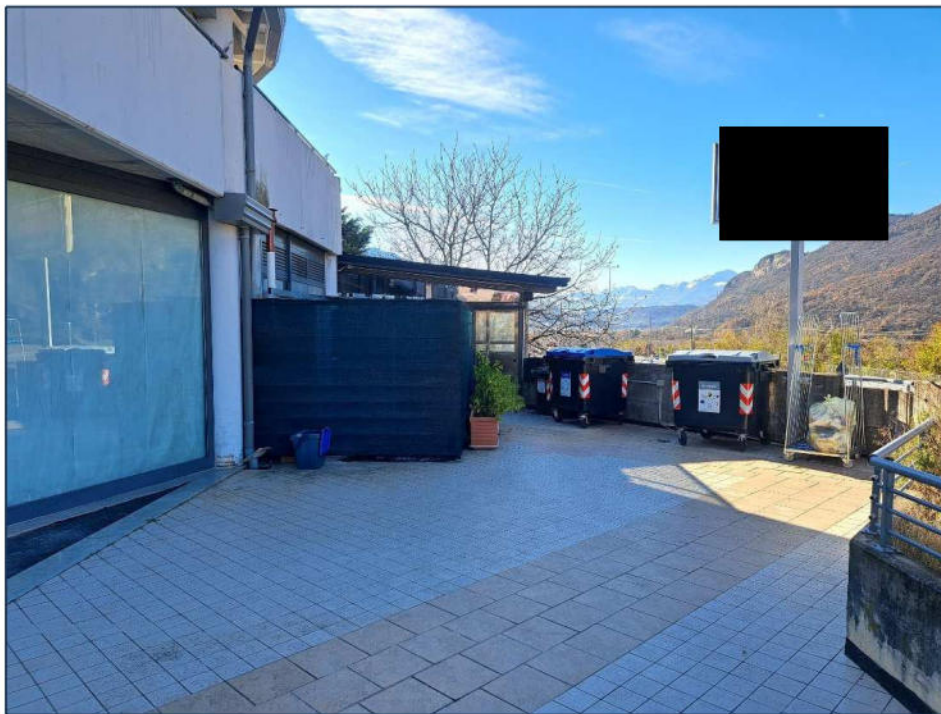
lastrico solare ovest soprastante il sub. 12 P.M. 10 – presa da nord.
